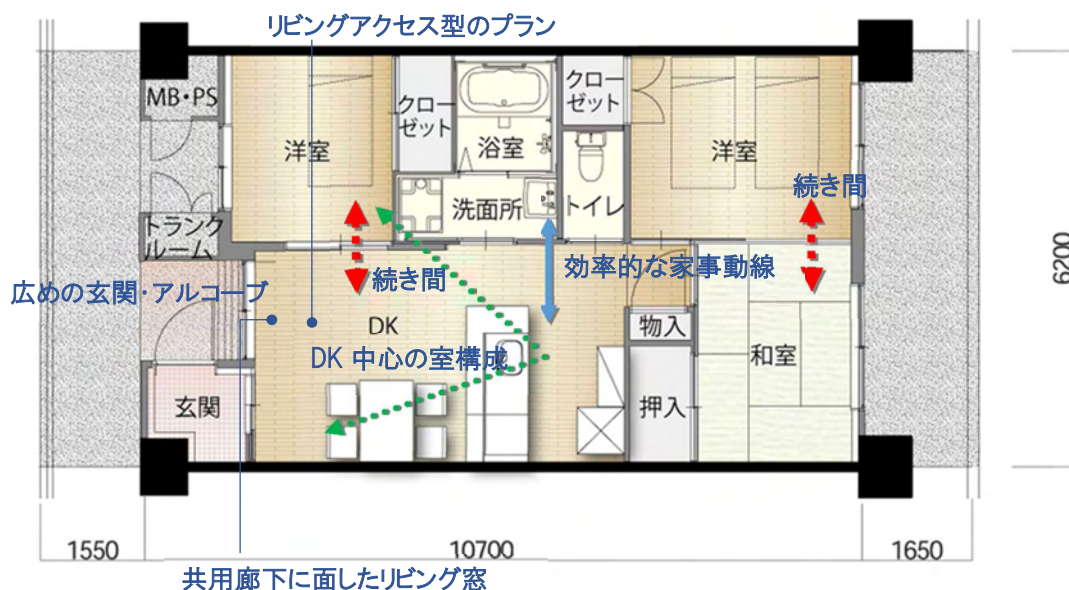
：3DK\_PLAN 約60㎡（3人以上世帯用）
